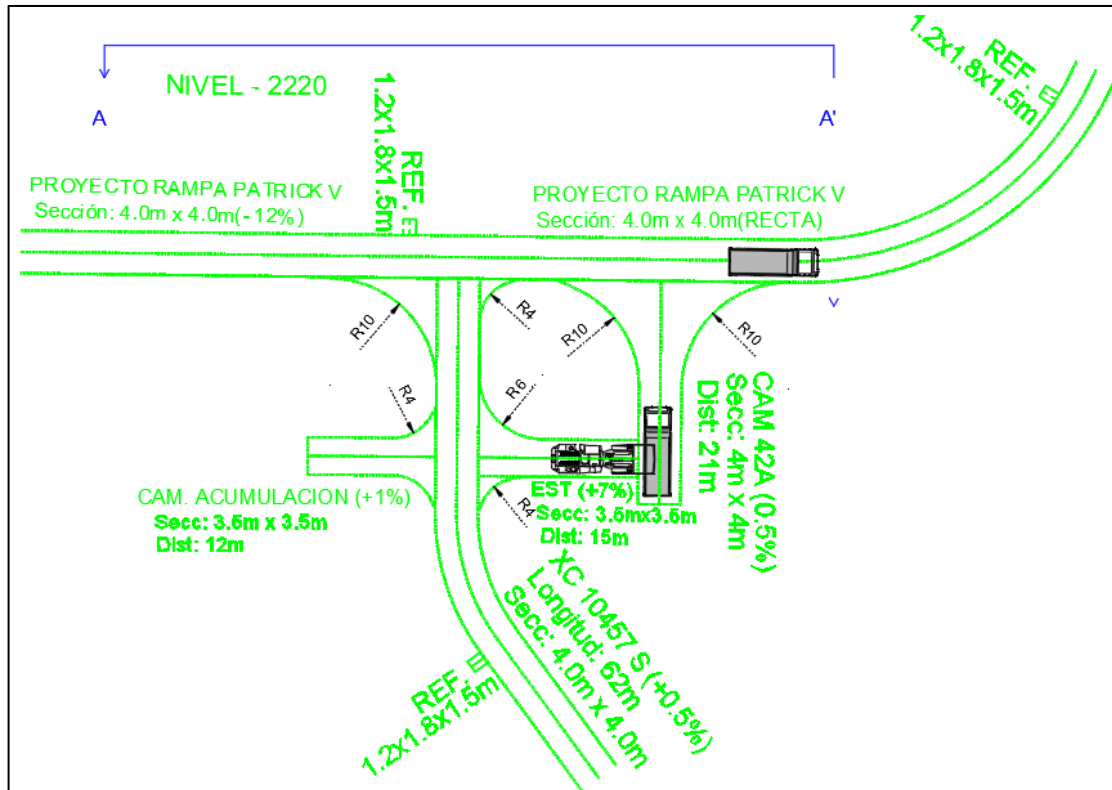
Vista en planta de la cámara de carguío tipo H
